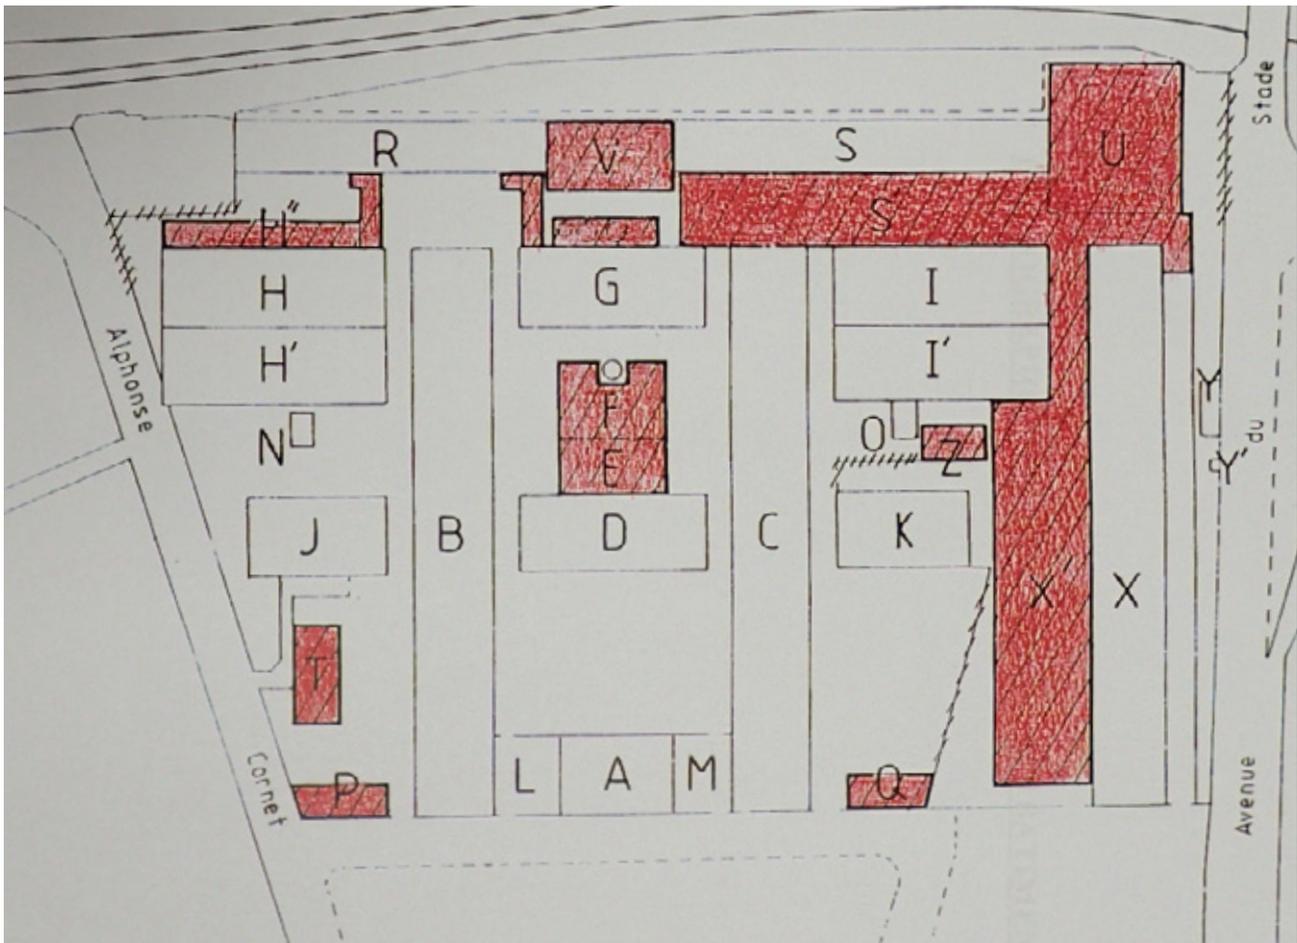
Manufacture des tabacs, Riom, plan du rez-de-chaussée, état en 1975.
